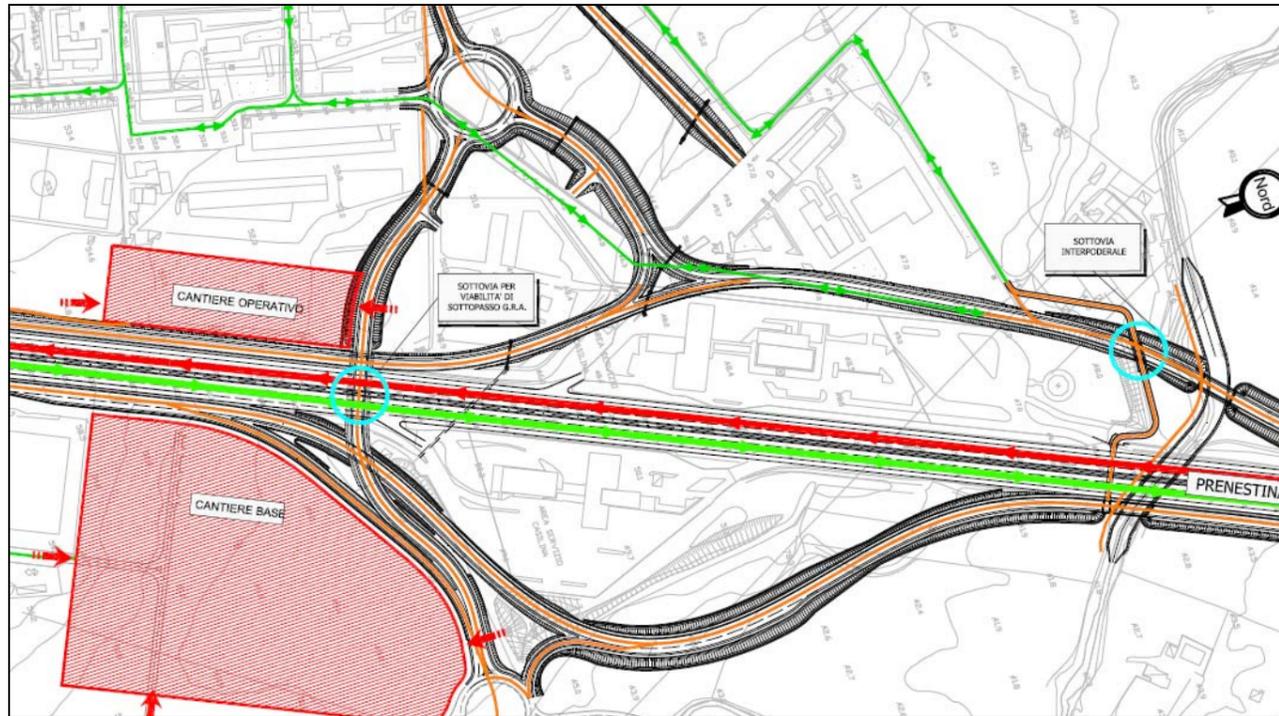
Stralcio piano di cantierizzazione (in rosso cantiere base e cantiere operativo)
